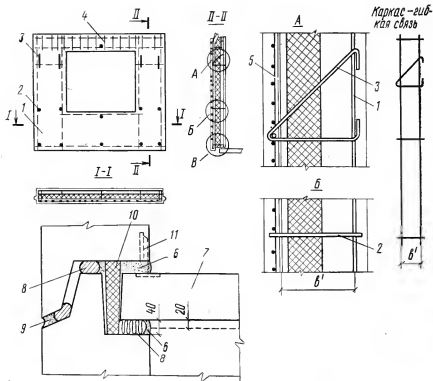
Схема армирования трехслойной навесной панели наружной стены [45]
